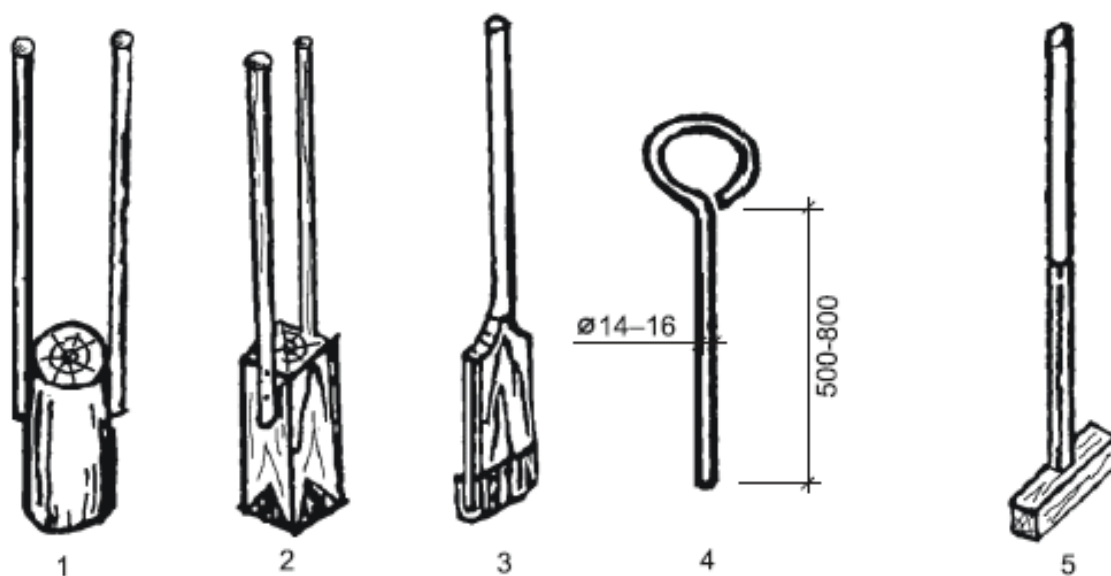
Инструменты для ручной укладки бетона: 1 – круглая трамбовка с двумя ручками; 2 – квадратная трамбовка с металлической обивкой; 3 – узкая трамбовка с металлической обивкой; 4 – шуп для штыкования диаметром 14–16 мм; 5 – гладилка для разравнивания бетона
